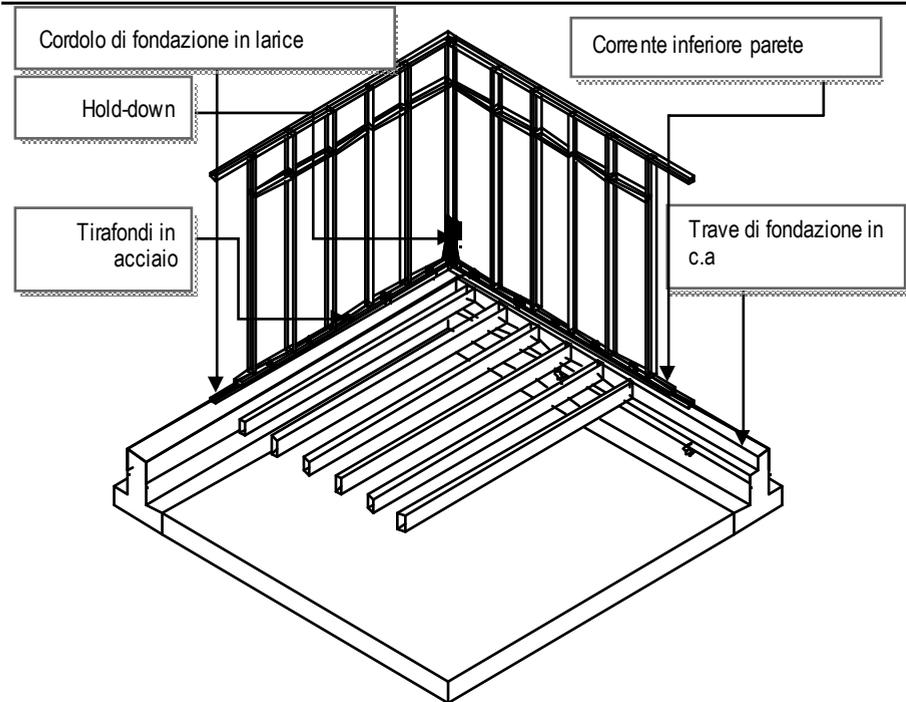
Collegamento alle fondazioni per un edificio Platform Frame.
